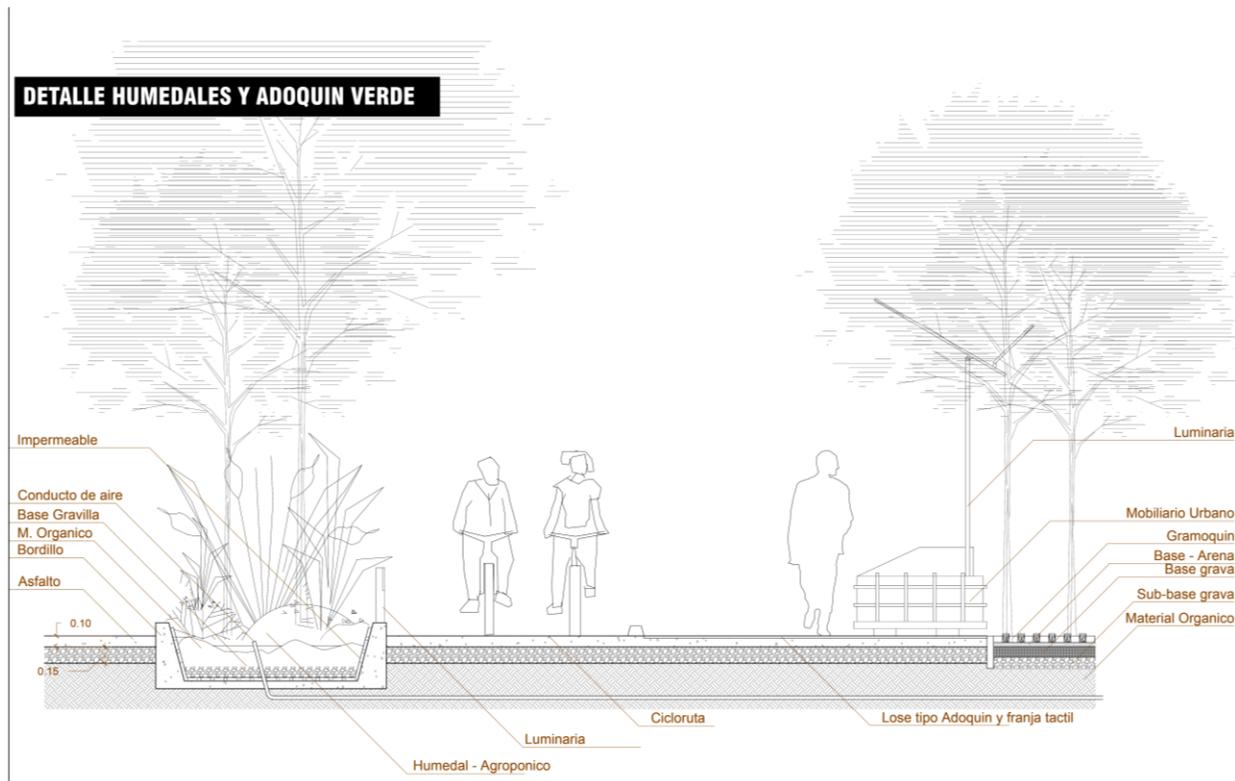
Vista – Detalles Constructivos. Fuente Propia.
